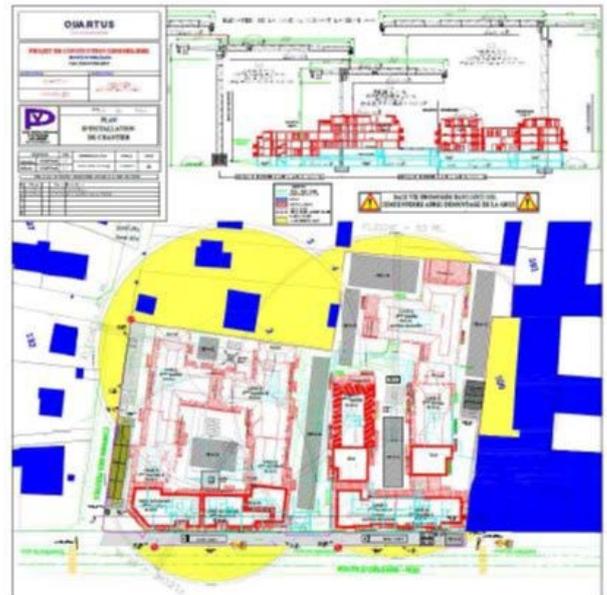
Plan d'installation du chantier (étude d'impact p.251)
